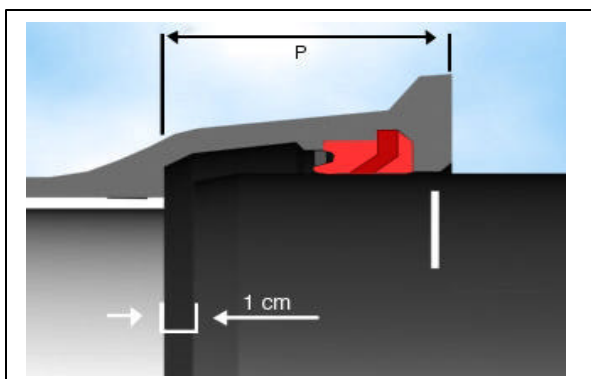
Concluída a montagem. o conjunto deverá apresentar a seguinte configuração.
